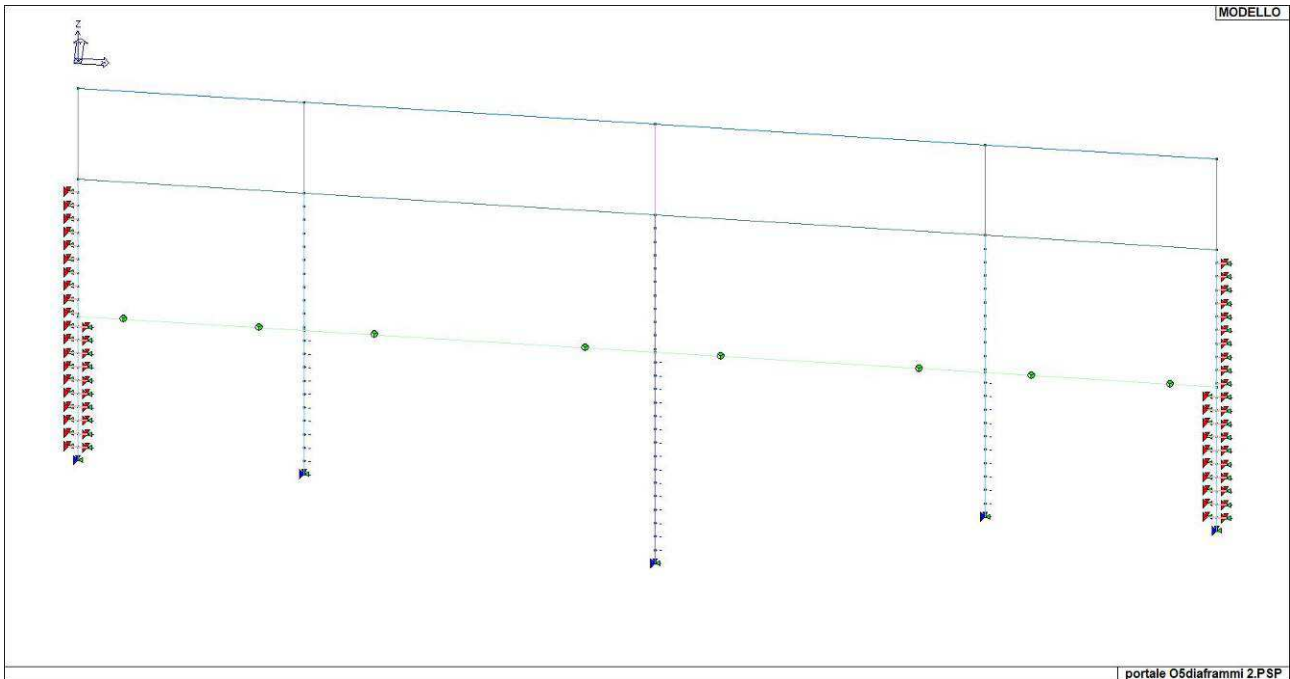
Vista unifilare del modello, sezione Tipo O' e O'' (5 diaframmi)
